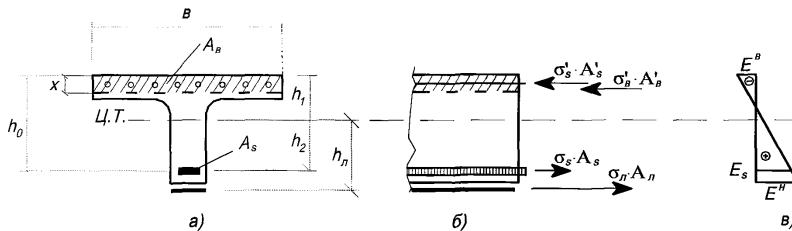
Схема усилий и эпюра относительных деформаций в сечении Т-обр. балки (+ - растяжение; - - сжатие)
